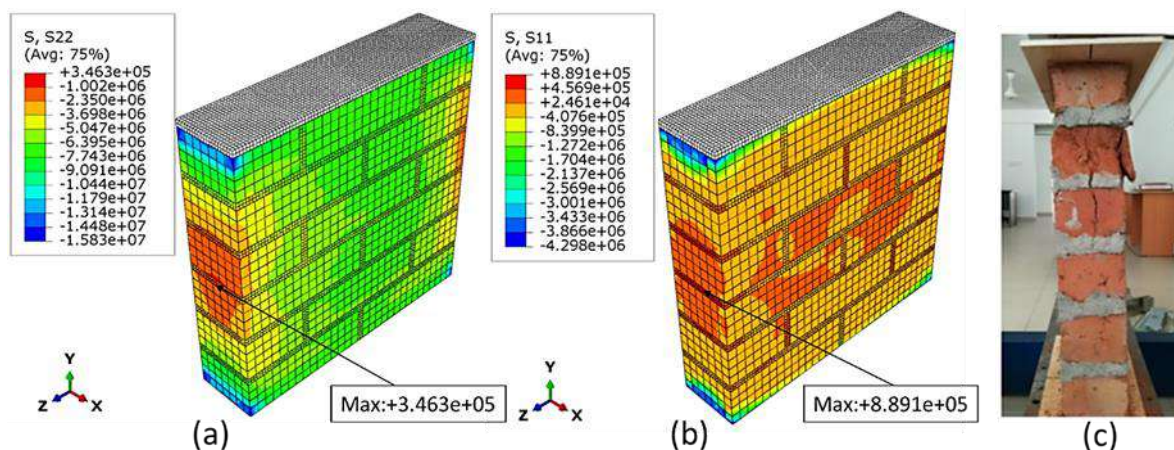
Tensiones verticales y transversales en el murete: a) Tensiones verticales, b) Tensiones transversales c) Fisura vertical del ensayo experimental [5]. Fuente: Elaboración propia.
